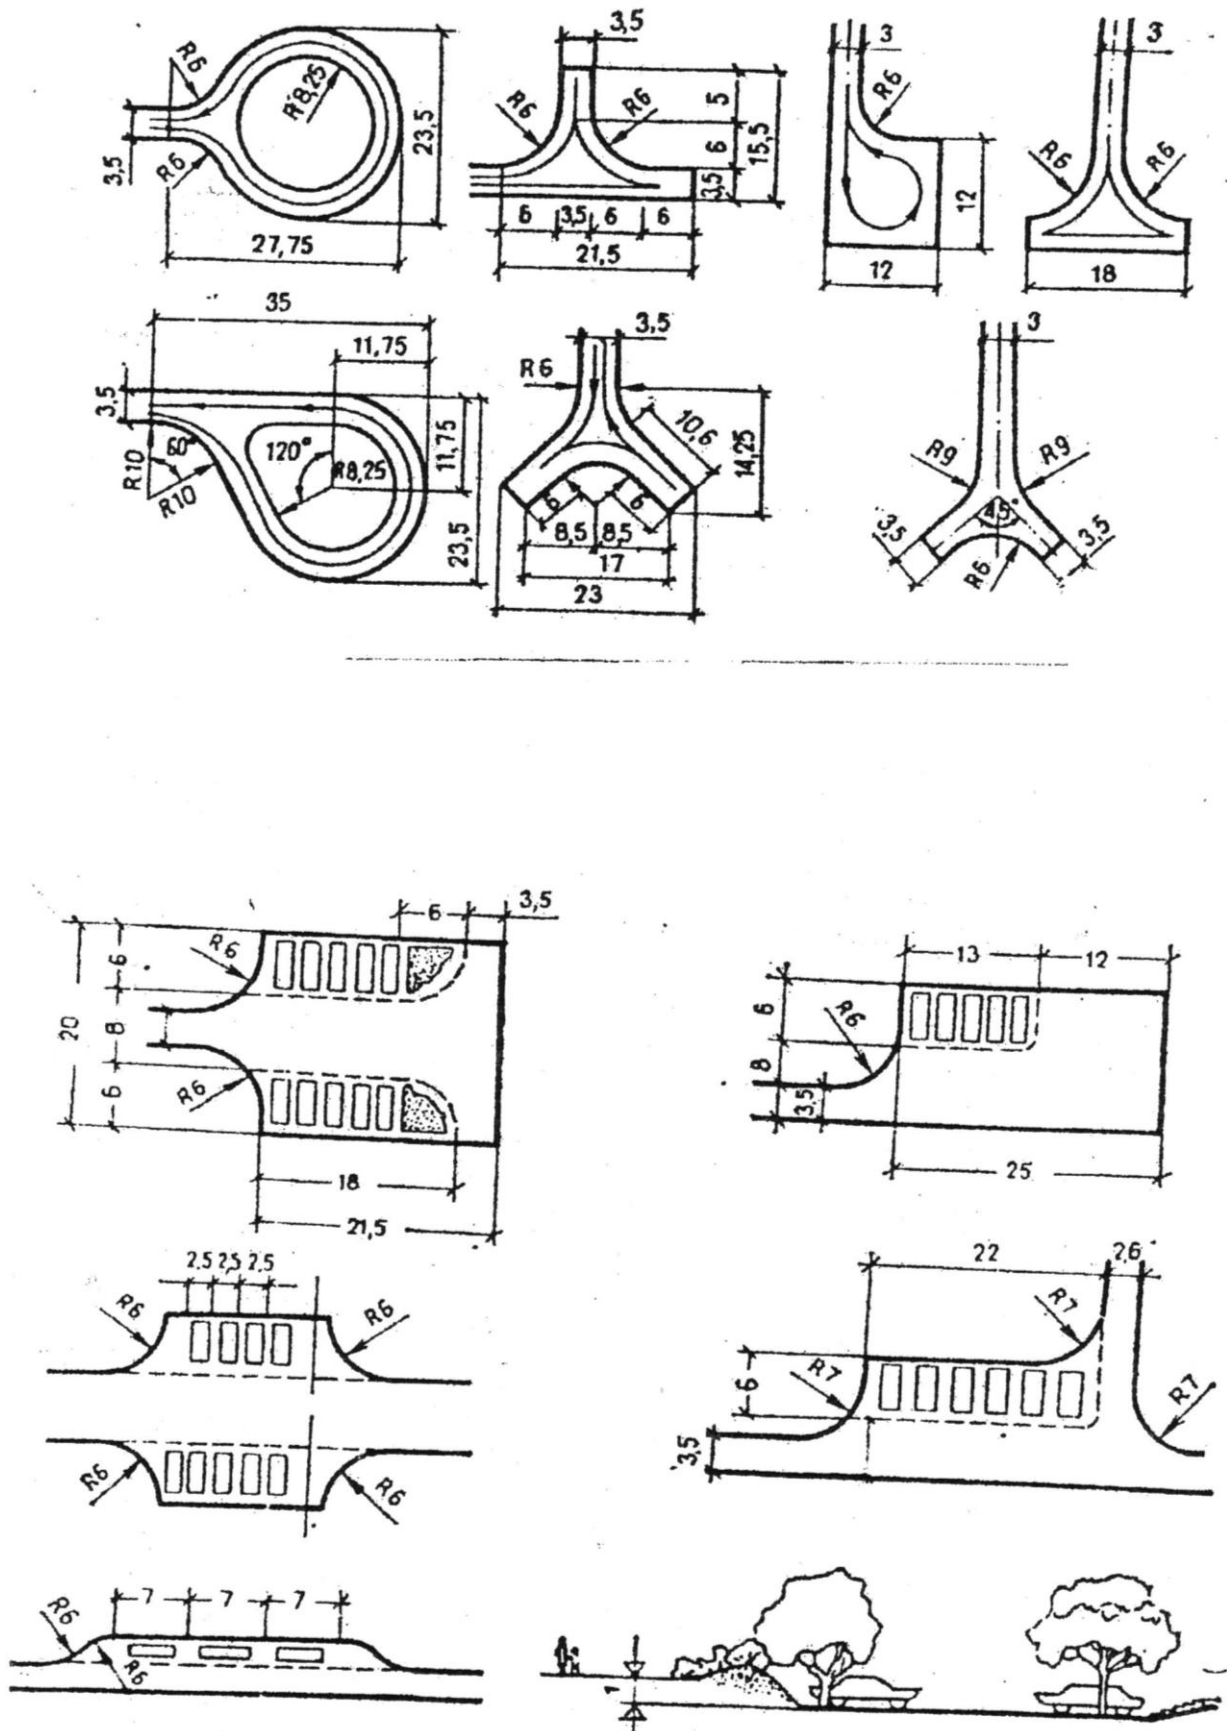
Схемы автомобильных стоянок и разворотных площадок для внутрипоселковых проездов транспорта.
